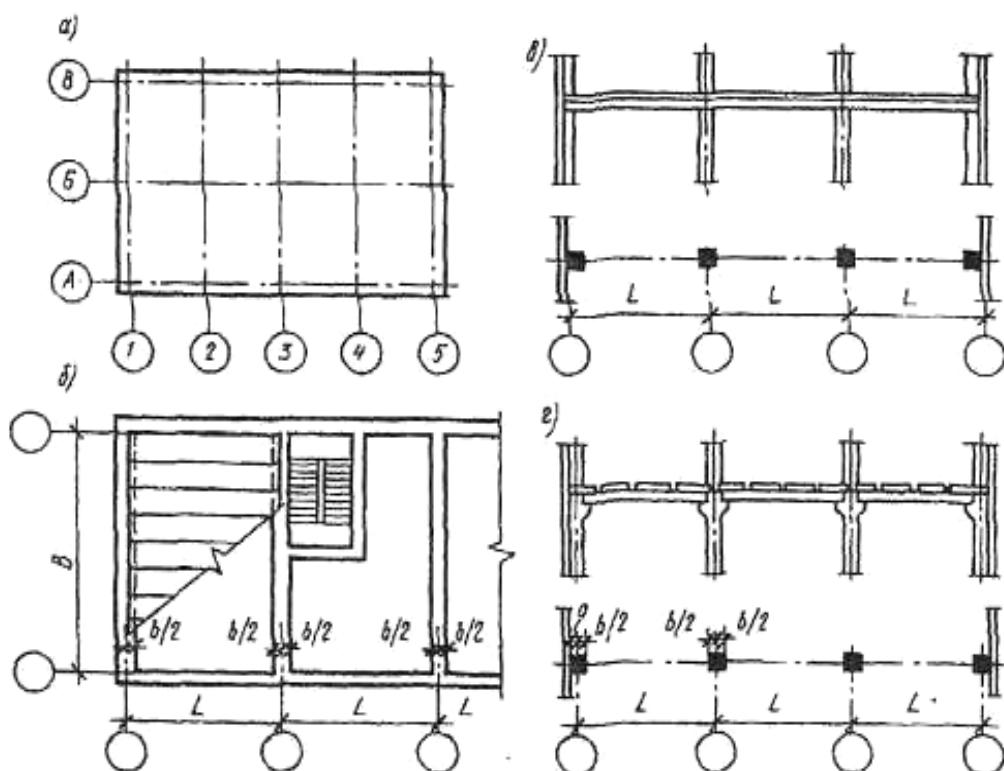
Схемы привязки к осям несущих элементов: а – обозначение осей в плане; б – привязка стен к осям здания; в – каркасный вариант; г – привязка колонн в плане
